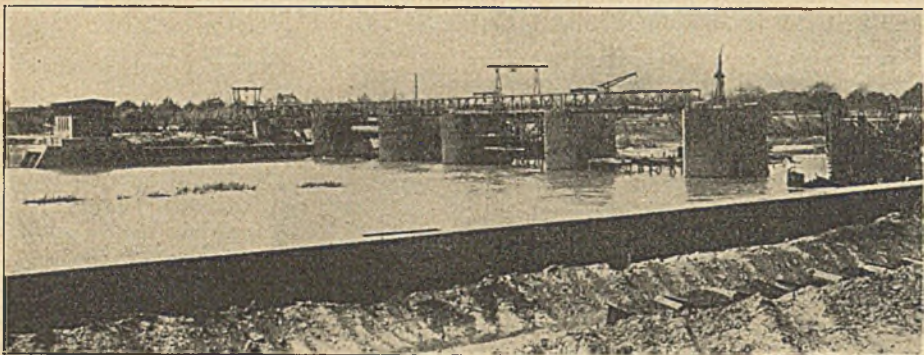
Staustufe Wieblingen, unterhalb Heidelberg. Wehr mit 6 Öffnungen von zusammen 148 m Lichtweite, Nebenkraftwerk und Kanaleinlaß im Bau.
